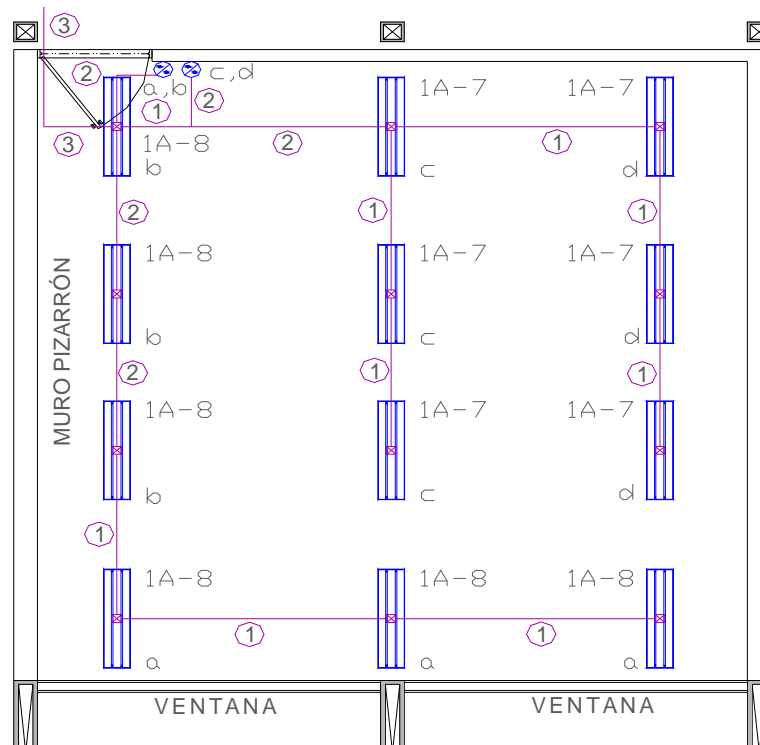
Detalle del sistema eléctrico para iluminación propuesto en un salón de clase.
